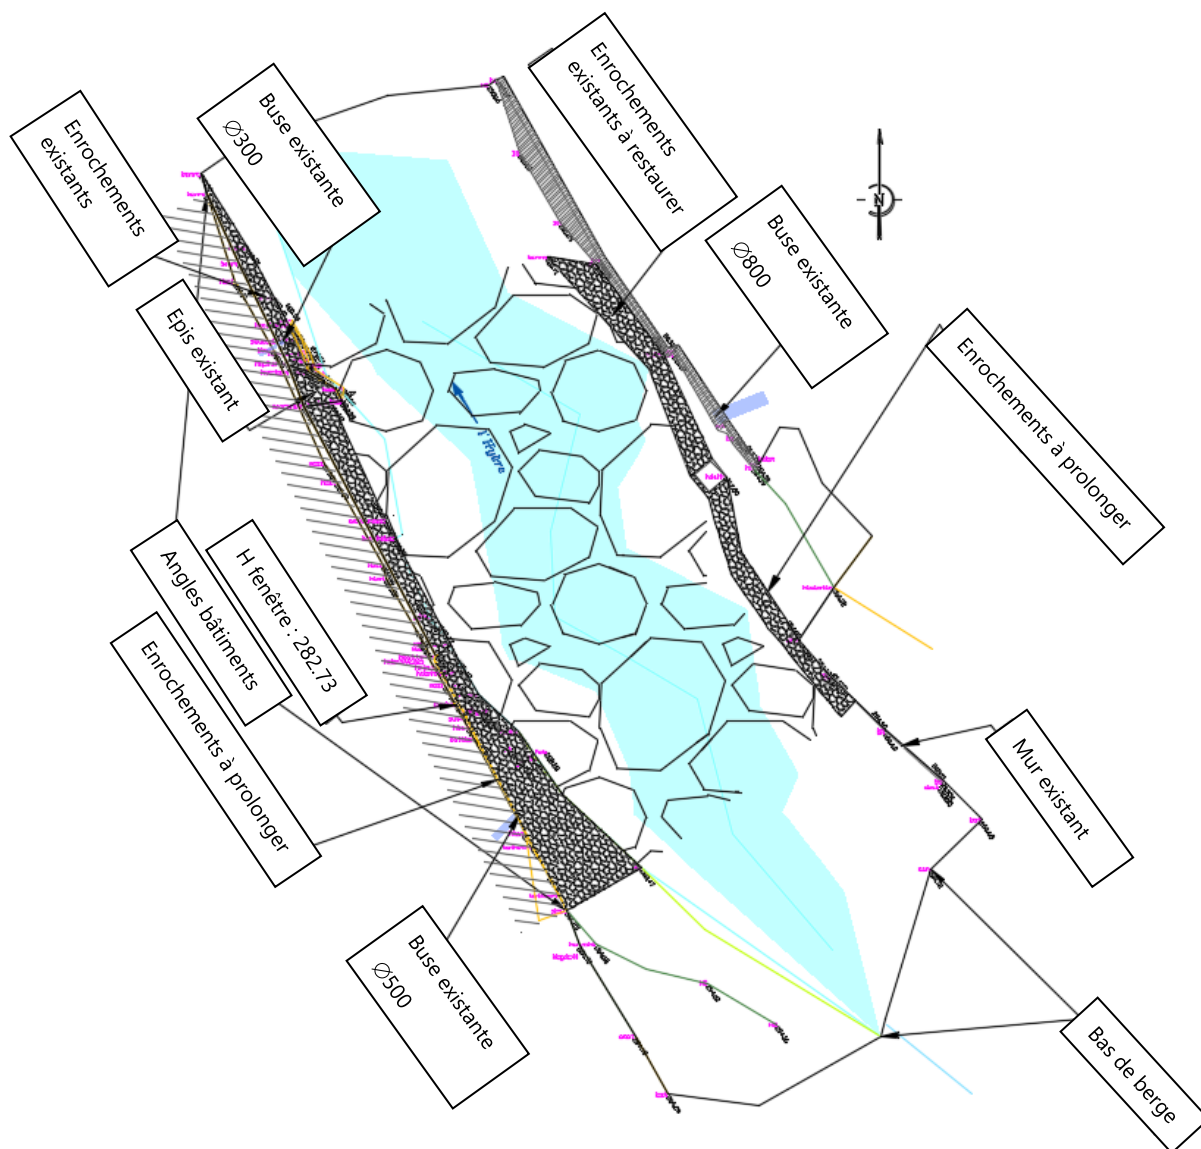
Principe de l'aménagement de rampe continue en enrochements libres – Vue en plan
